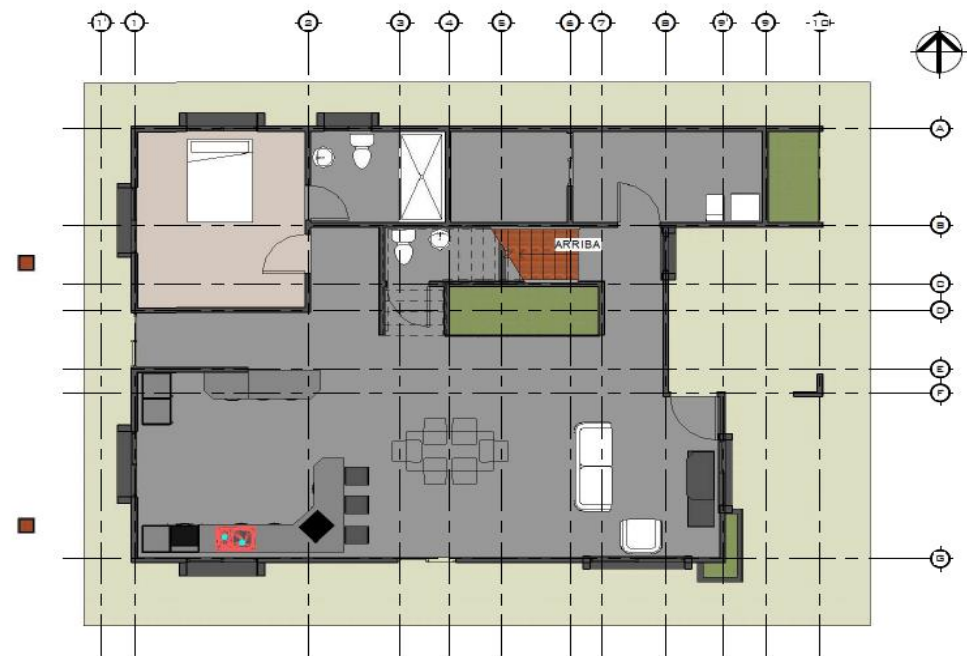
Planta arquitectónica modelo Guayacán. Primer nivel.
